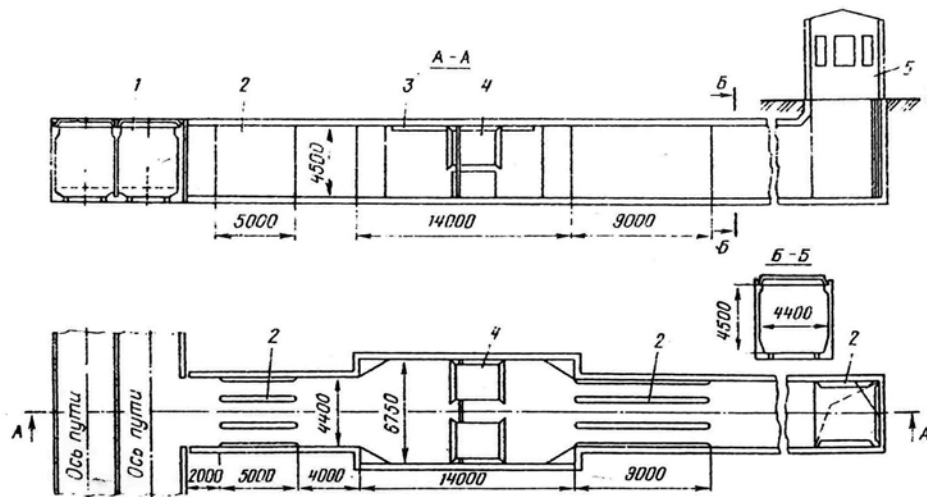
Вентиляционные сооружения на перегоне мелко заложённой линии: 1 – перегонный туннель; 2 – шумоглушительные перегородки; 3 – монтажные балки; 4 – вентиляторы; 5 – вентиляционный киоск
